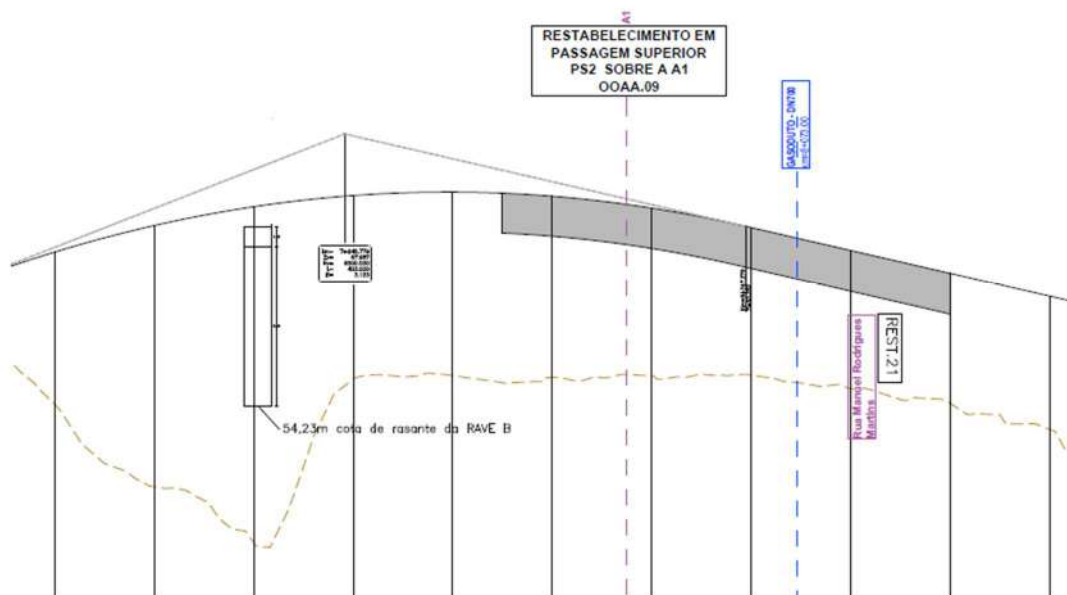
Localização da RAVE (Solução B) e do projeto em estudo – Perfil Longitudinal
